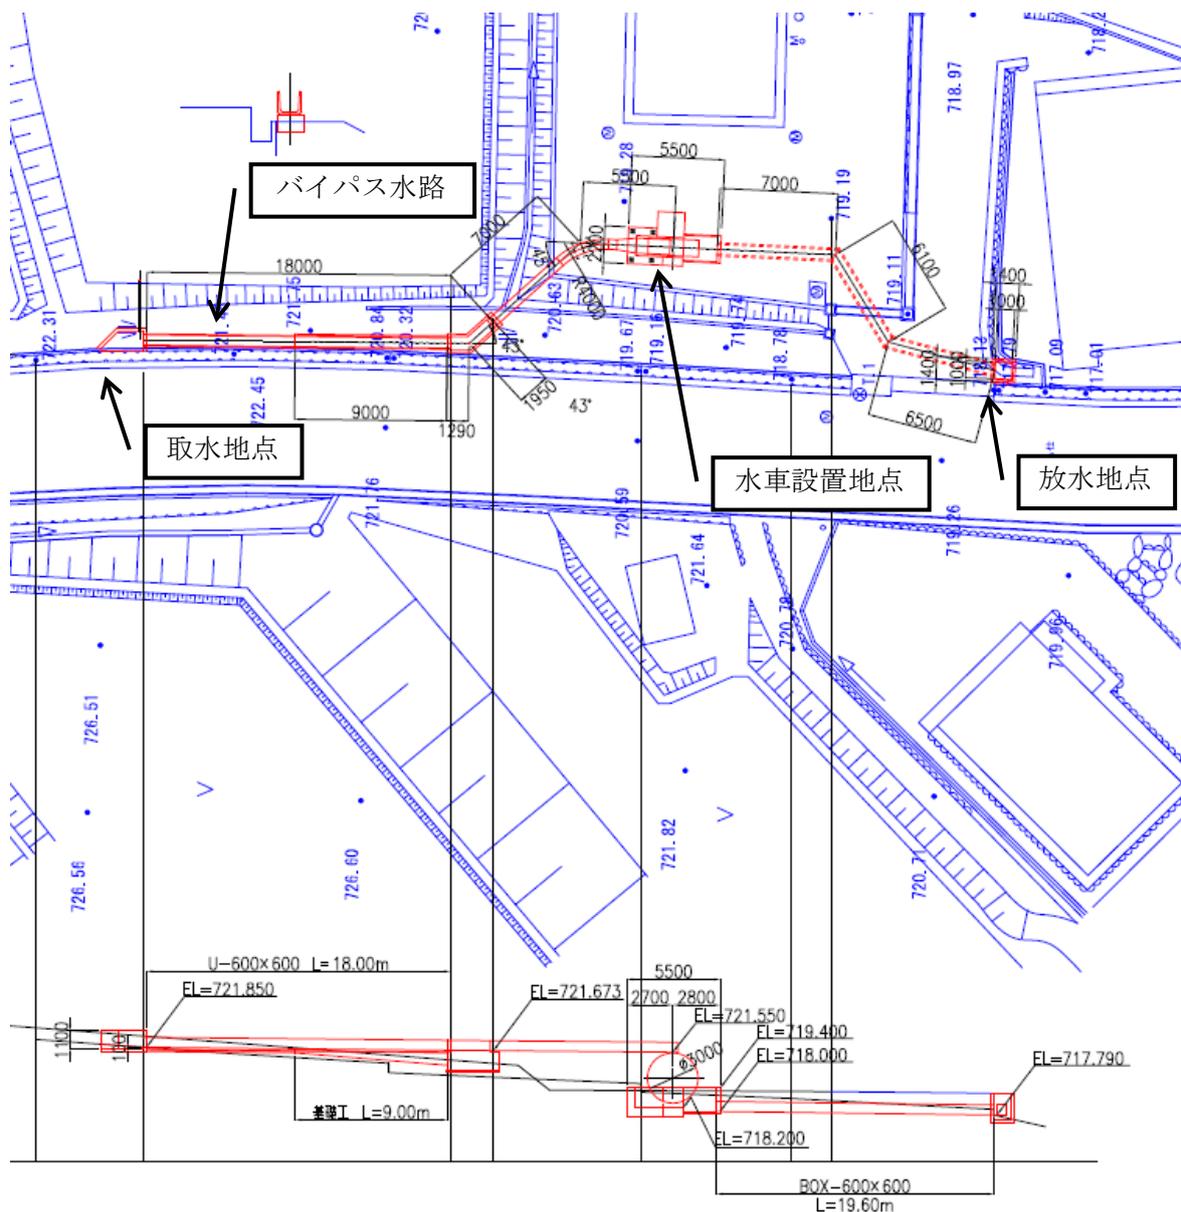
上掛け水車設置の施工図。上段が平面図、下段が縦断図。
